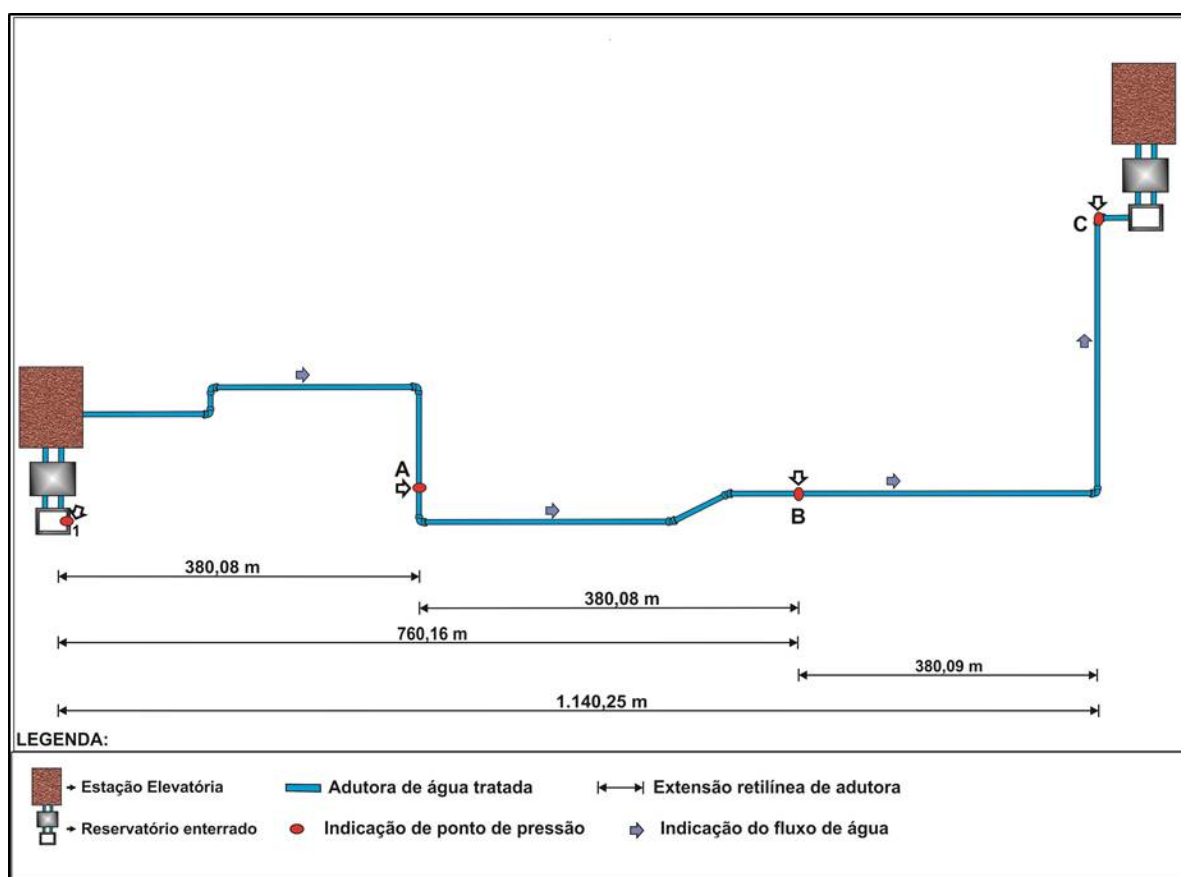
Esquema da planta baixa do sistema de adução em estudo.
